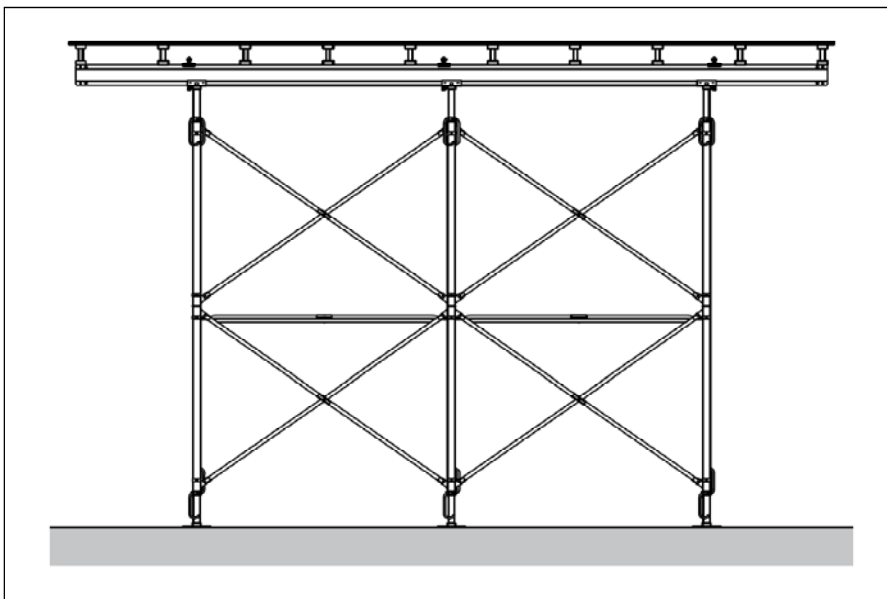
Trägerschalung mit Traggerüst⁴⁸¹
